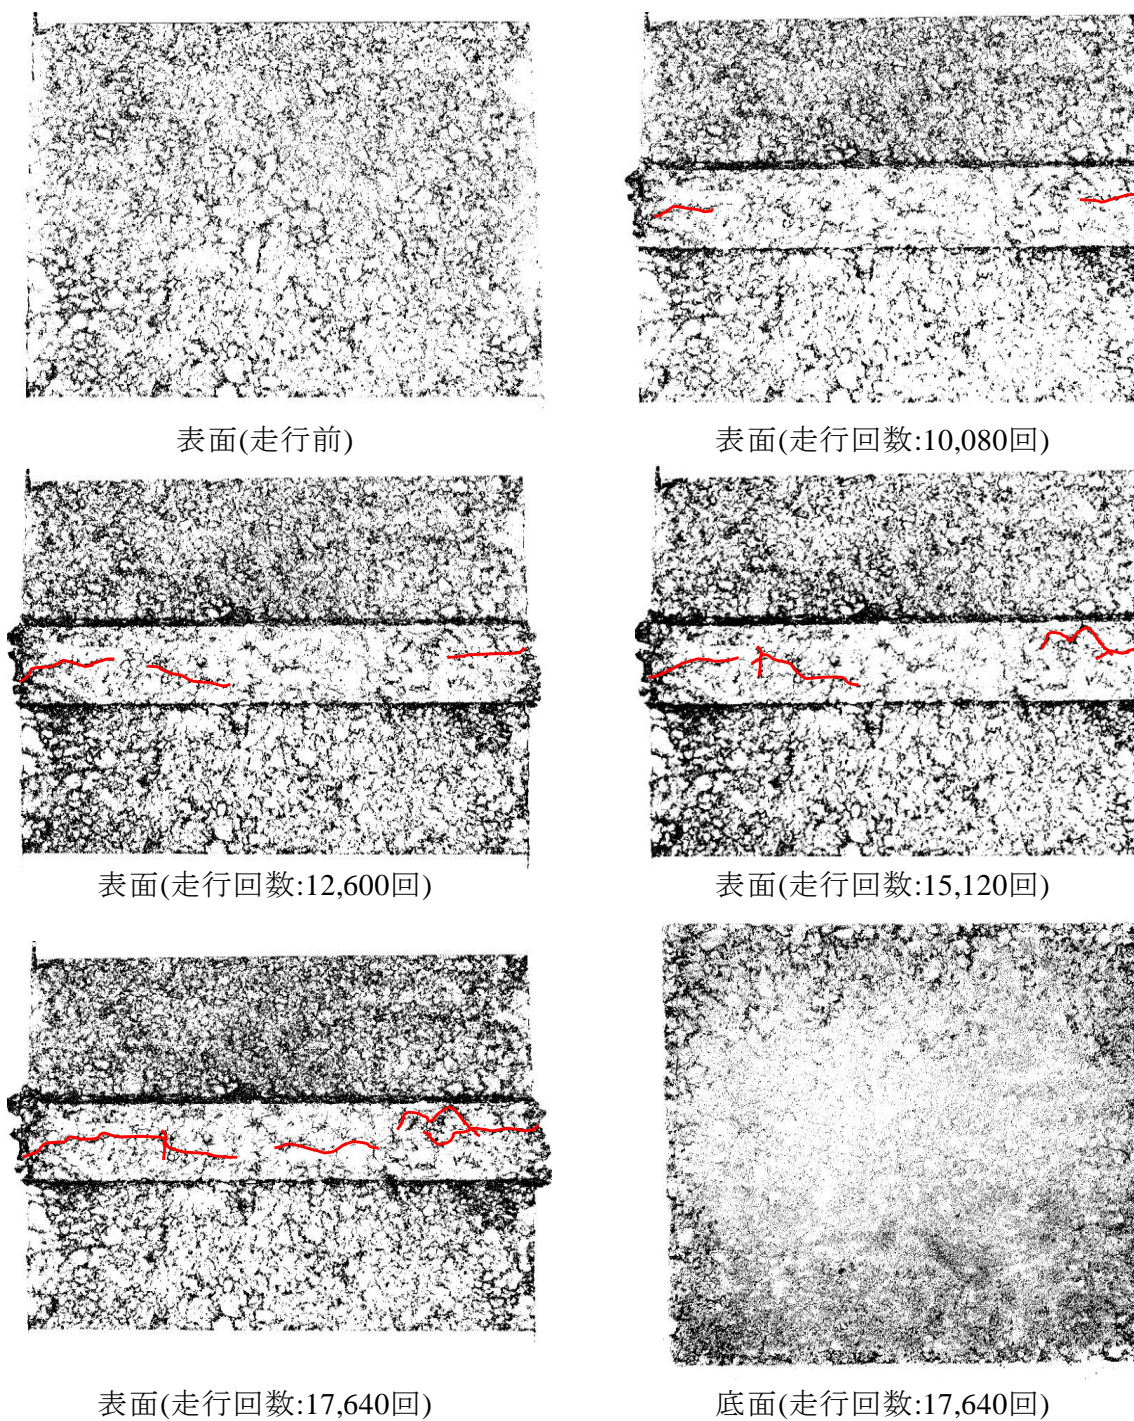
車輪走行部の表面でひび割れが生じた供試体の断面写真
